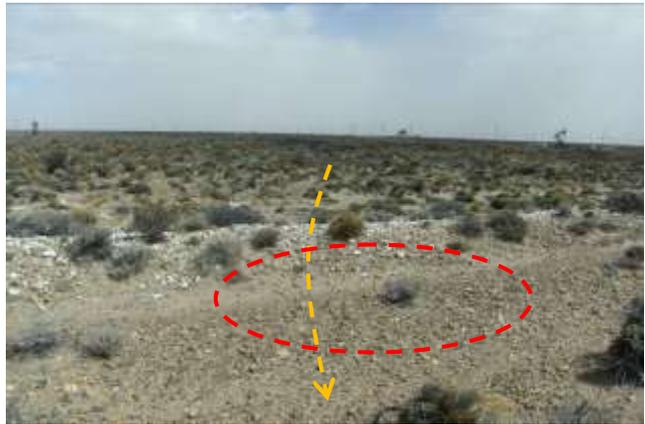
Emplazamiento de oleoducto- por terreno virgen. Cruce con ducto soterrado (gasoducto) (rojo). Foto en dirección NO.
